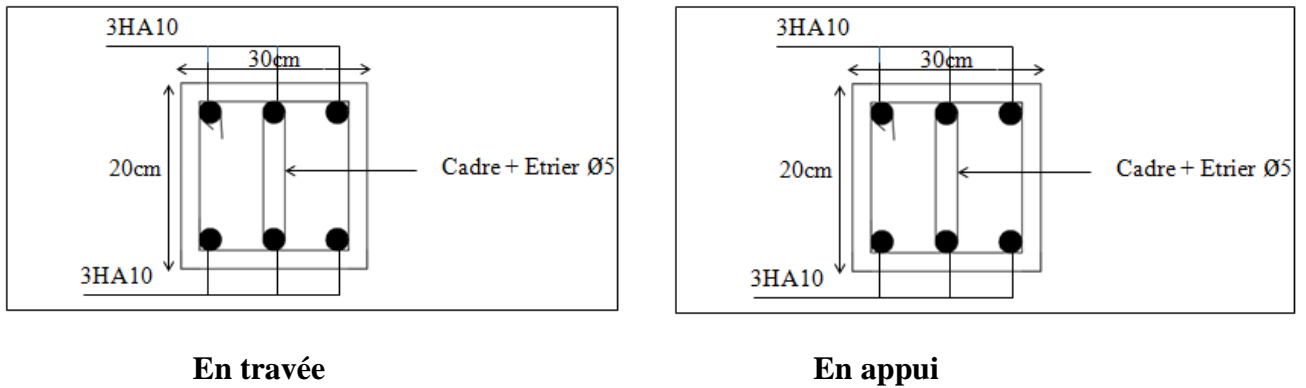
Schéma de ferrailage de la poutre de chaînage..
